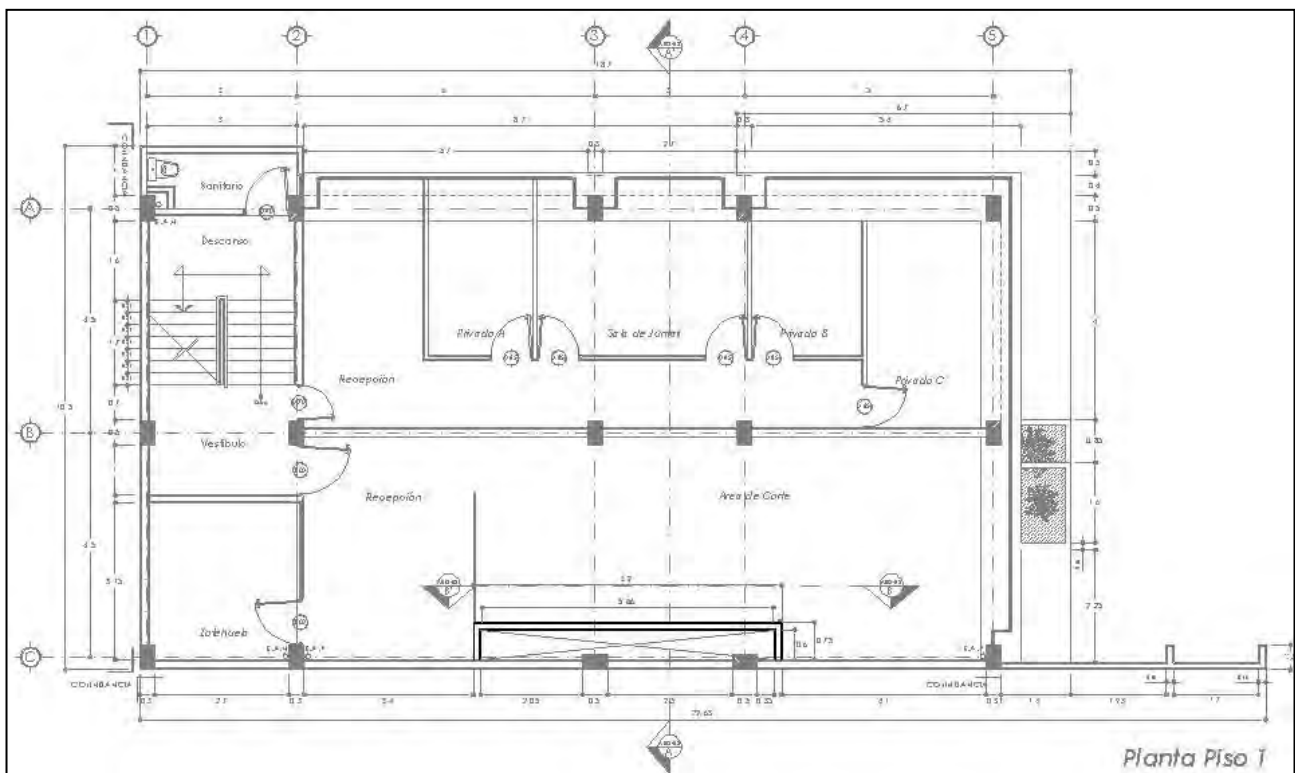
Planta Piso 1 Proyecto Arquitectónico SIIN
